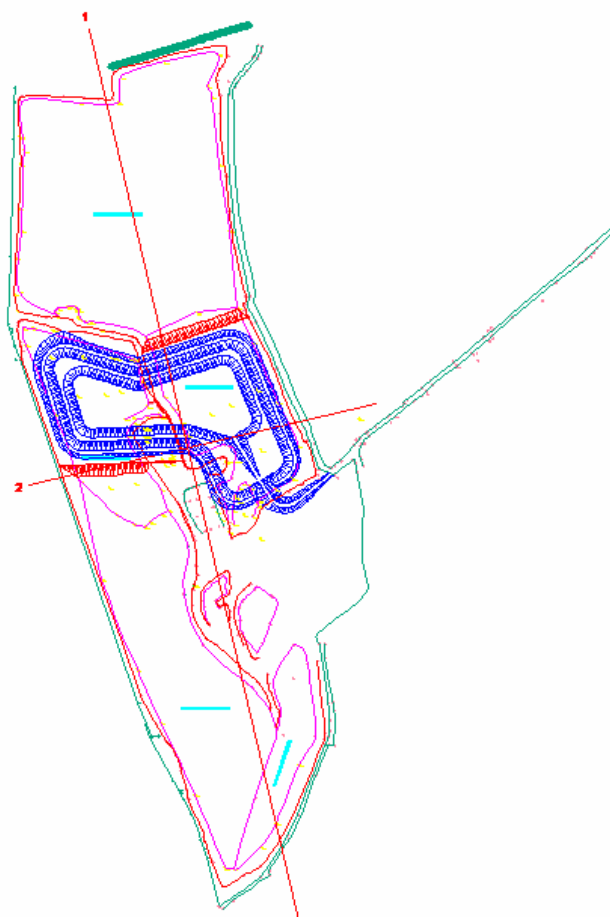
Planimetria del deposito CRA4 con indicazione delle sezioni di calcolo
